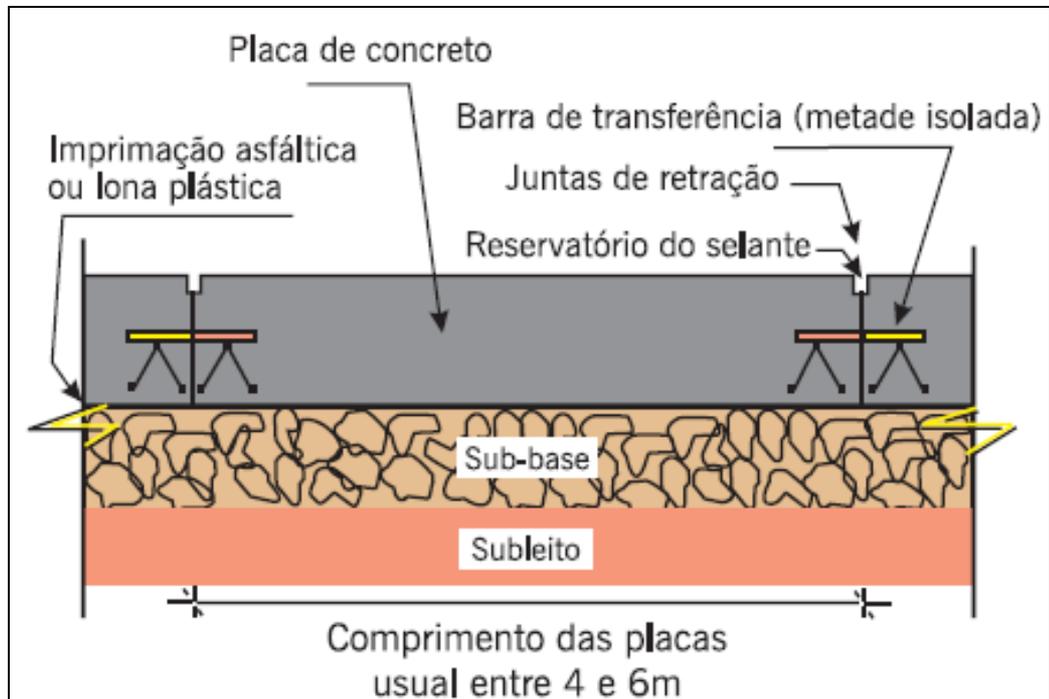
Pavimento de concreto-corte longitudinal (BERNUCCI et al., 2006)
